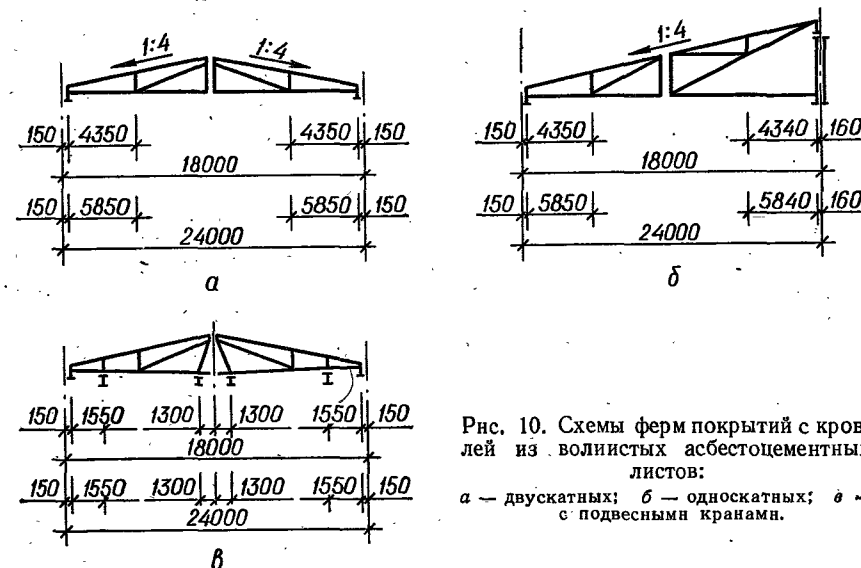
Схемы ферм покрытий с кровлей из волнистых асбестоцементных листов:
